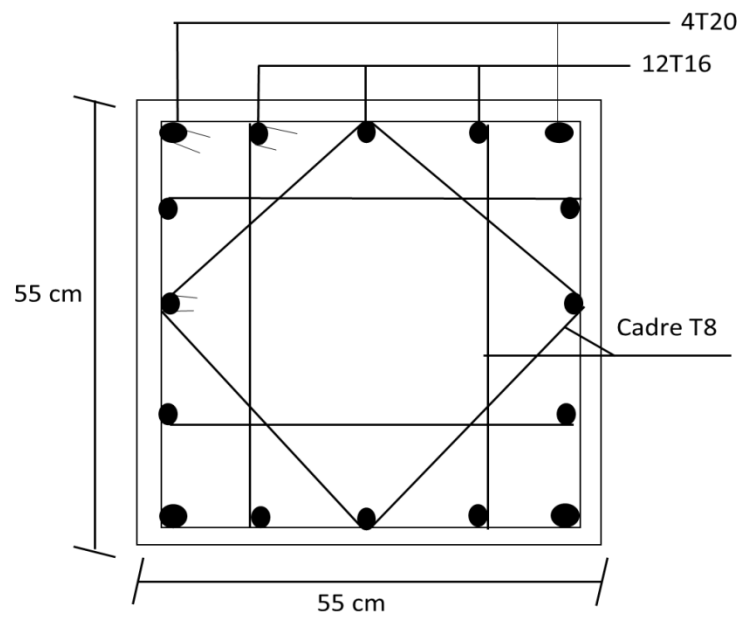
schéma du ferraillage Poteau 6^{ème} et 5^{ème} étage.
